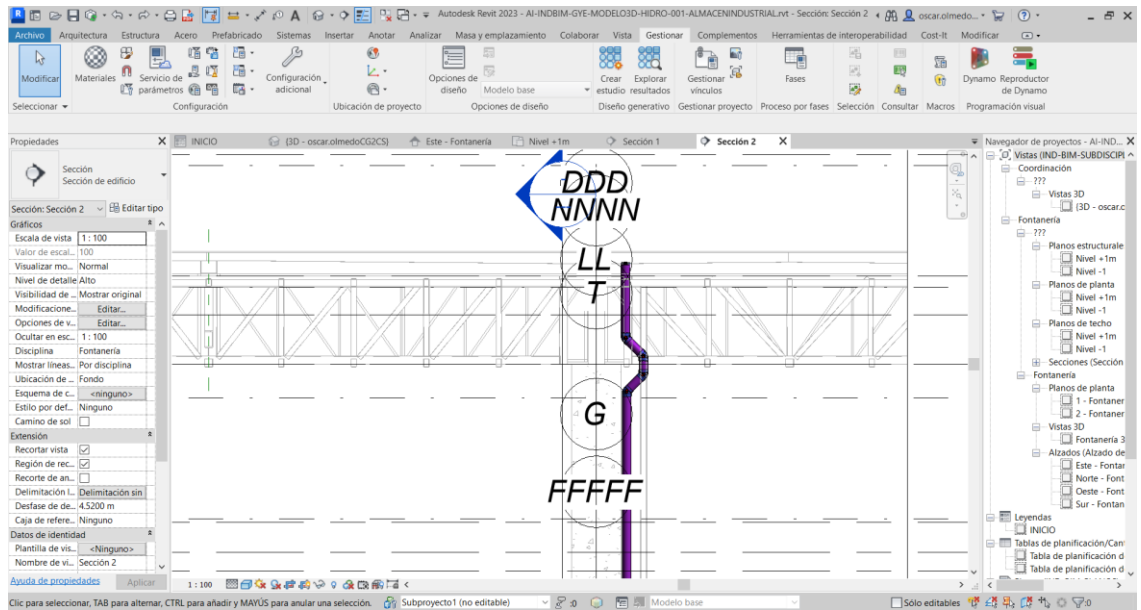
Detección de la colisión en corte o sección. Elaboración propia
